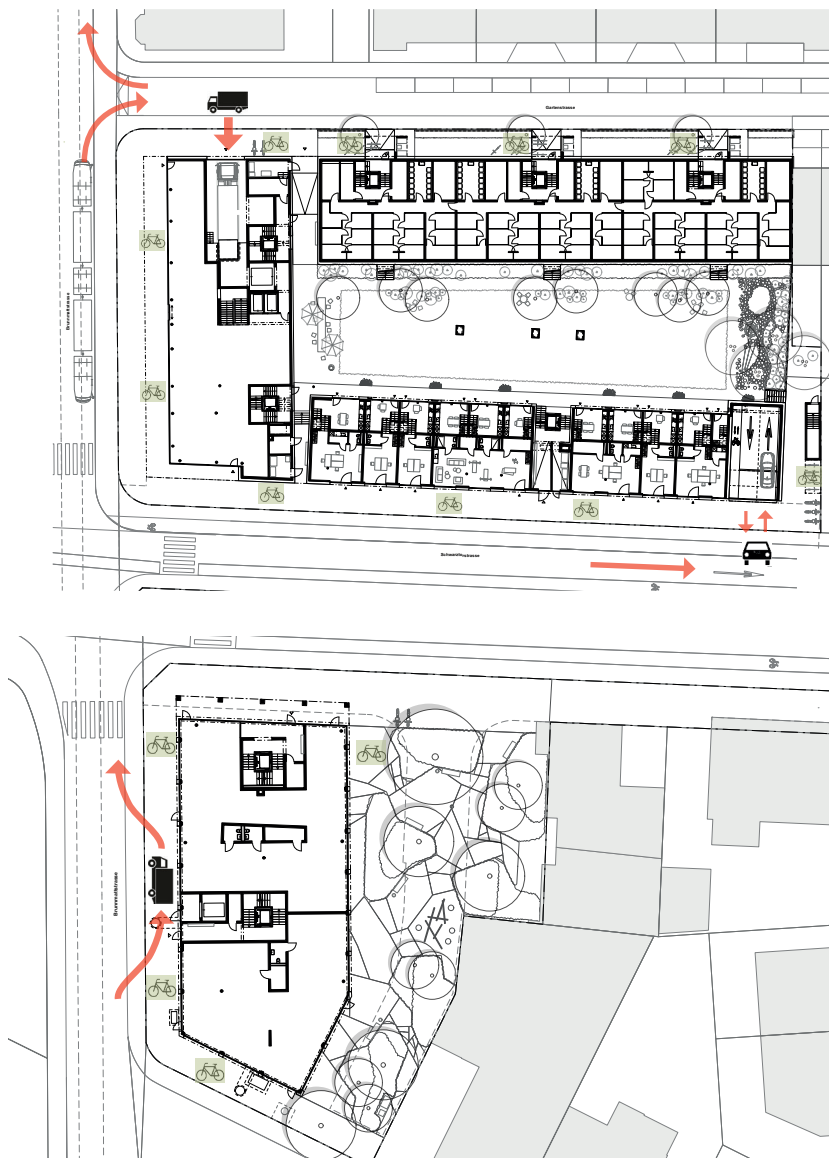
Schemaplan Anlieferung, Erschliessung und Parkierung Fuss- und Veloverkehr
